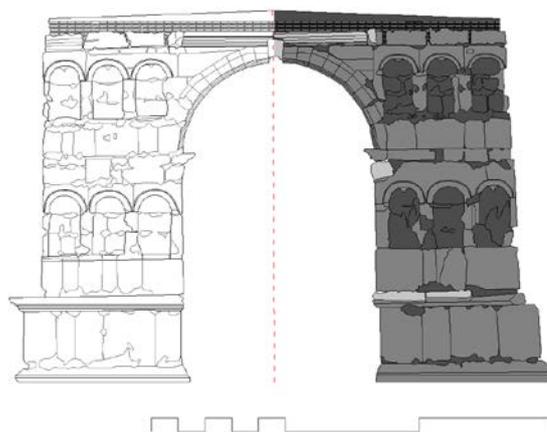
Levantamiento arquitectónico del arco. Alzado.
